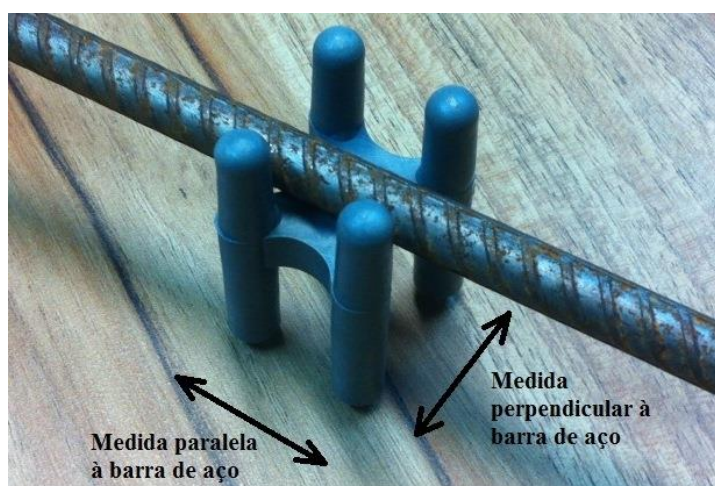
Desenho explicativo do requisito de desempenho dimensional, dimensões mínimas.
